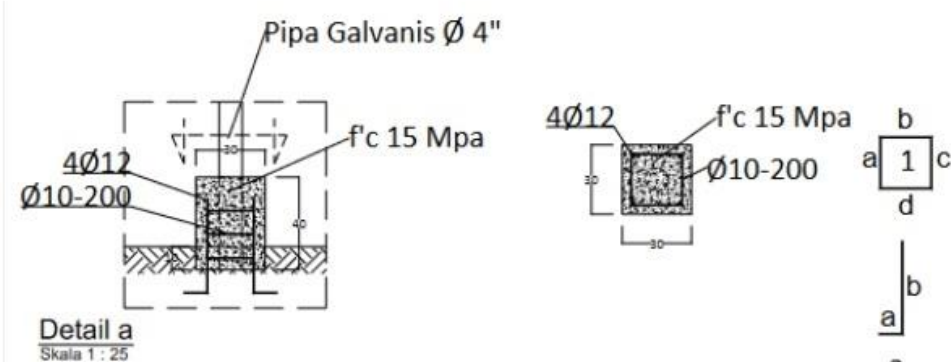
DETAIL RENCANA STRUKTUR KOLAM ANEROBIK 1
